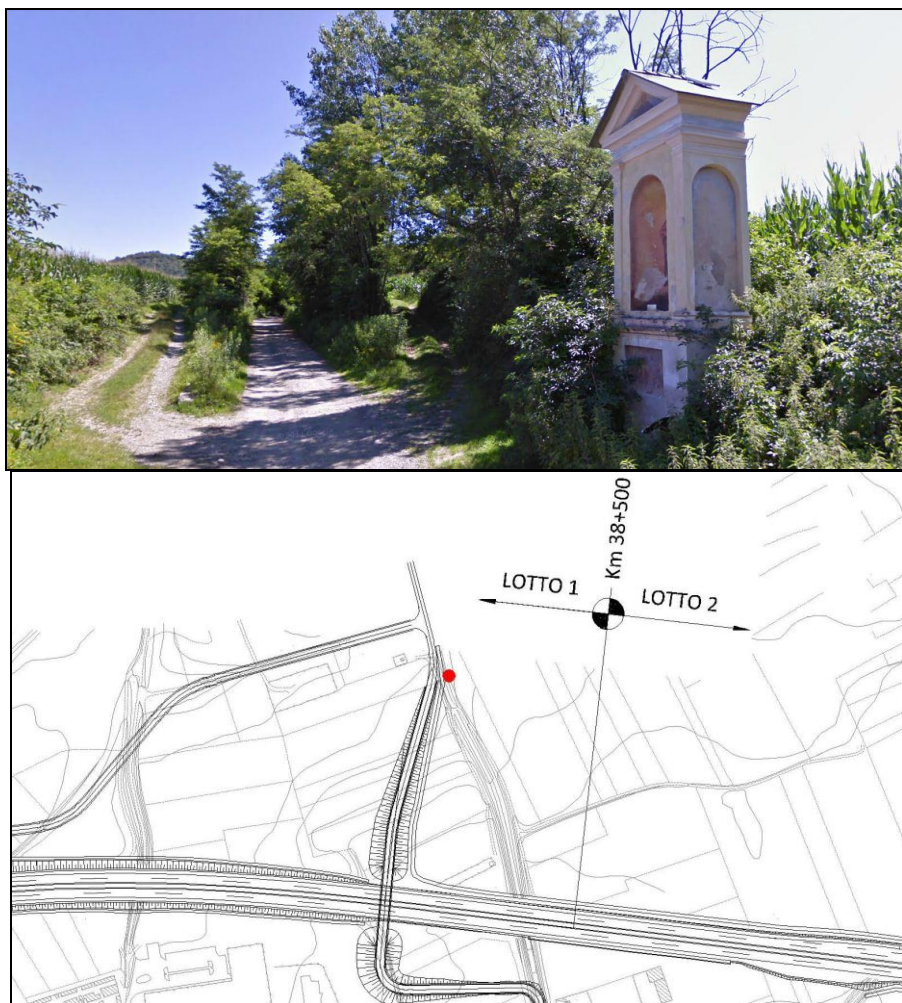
/21 Cappelletta lungo la viabilità interpodereale interessata dalle piste di cantiere
